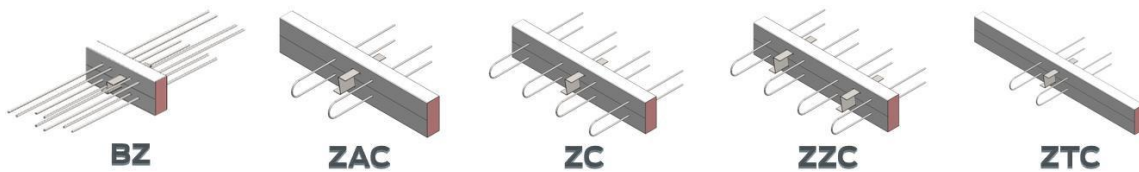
Vue 3D des modèles de traitement des linéaires dalle pleine – balcon – Procédé Slabe 8
